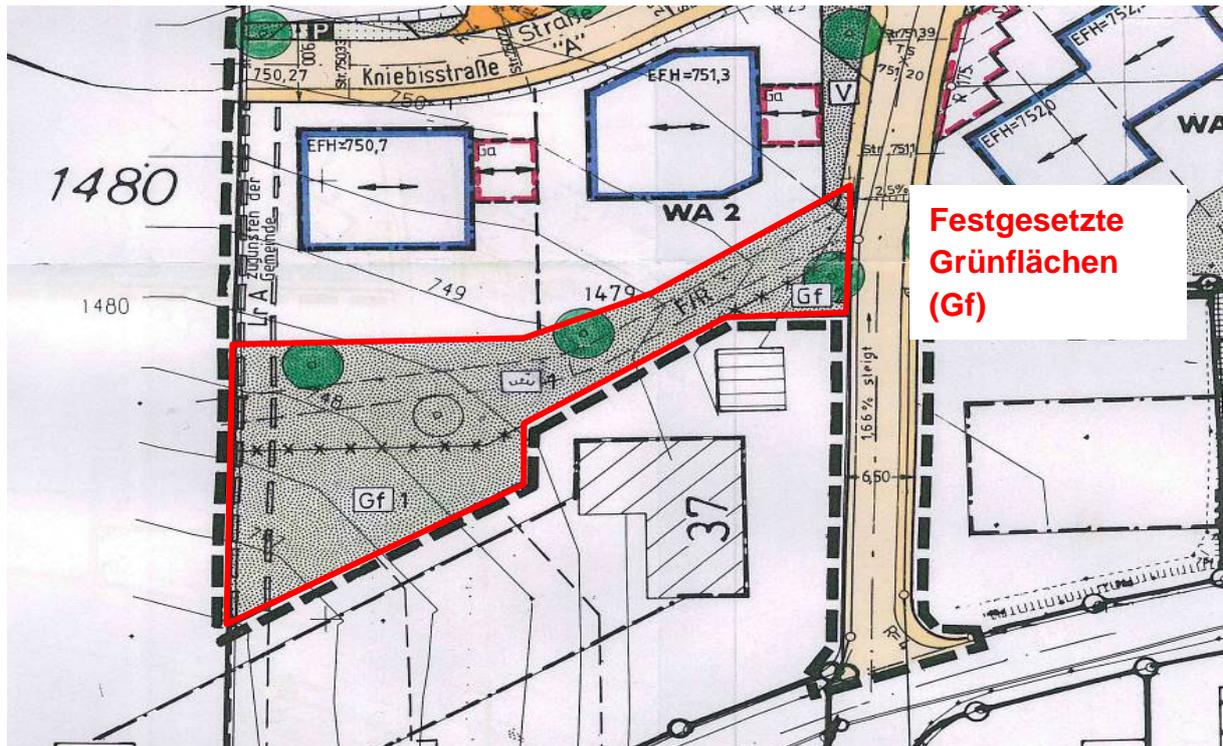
Auszug aus dem Bebauungsplan „Ehrenschof 1. Änderung“.
